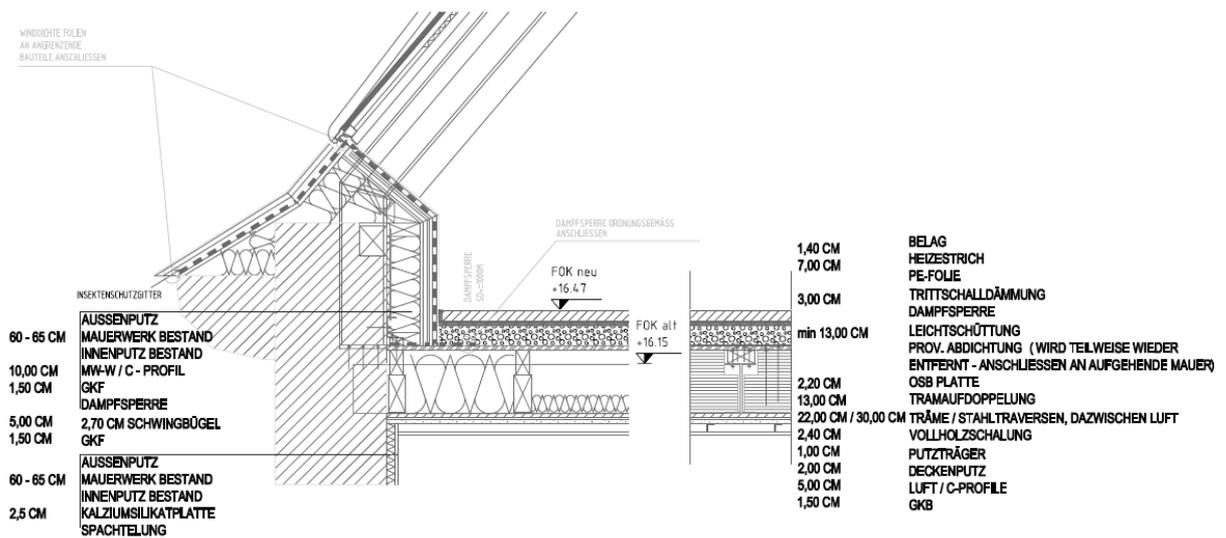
Tramtraversendecke – Konstruktionsdetail im Dachgeschoß (Quelle: Architekten Kronreif\_Trimmel & Partner, angepasst durch Schöberl & Pöll GmbH)
